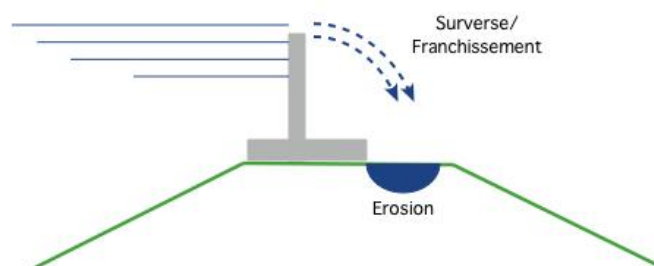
Surverse ou franchissement sur une digue en remblai rehaussée par muret (Schéma : Rémy Tourment)
